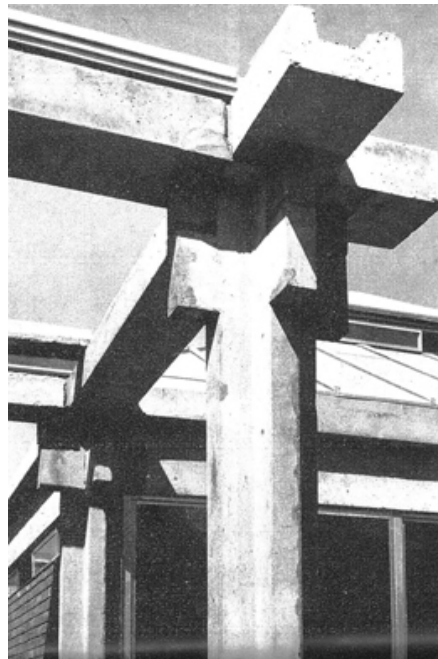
fotografía del encuentro de un pilar en cruz, vigas y canal de agua lluvia.
